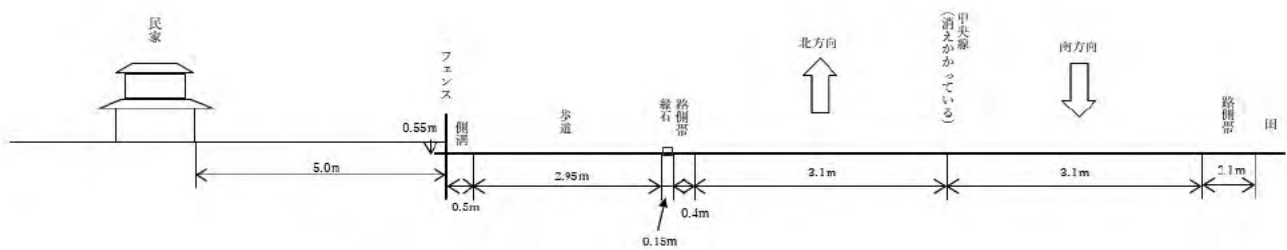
騒音予測地点bの詳細図及び道路断面図
